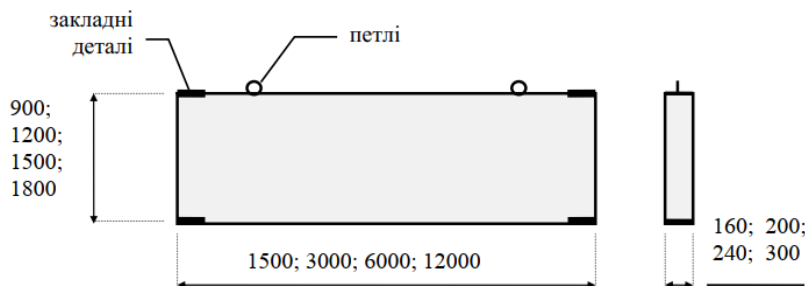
Конструкція стінової залізобетонної збірної панелі
